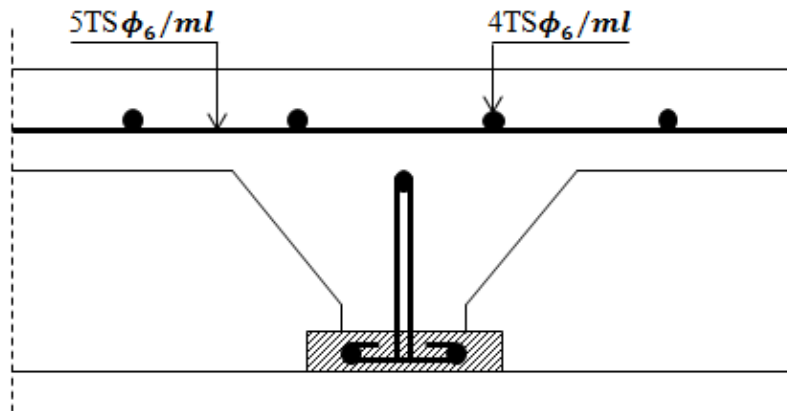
Schéma de ferrailage de la dalle de compression.
